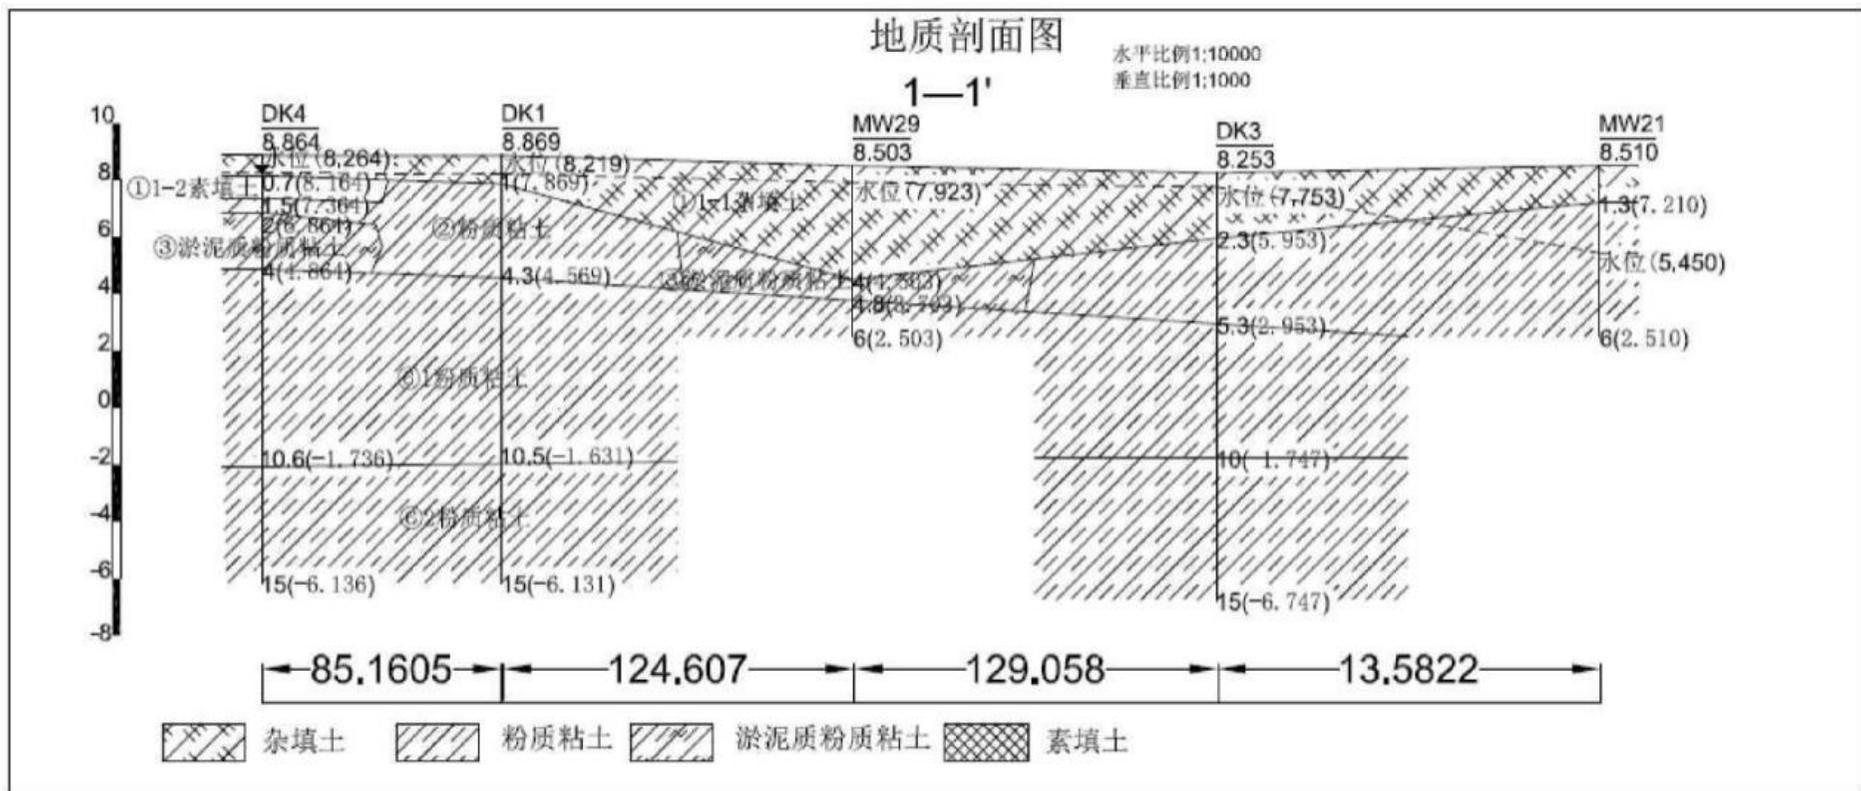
弘博新材料地块典型断面工程地质剖面图
